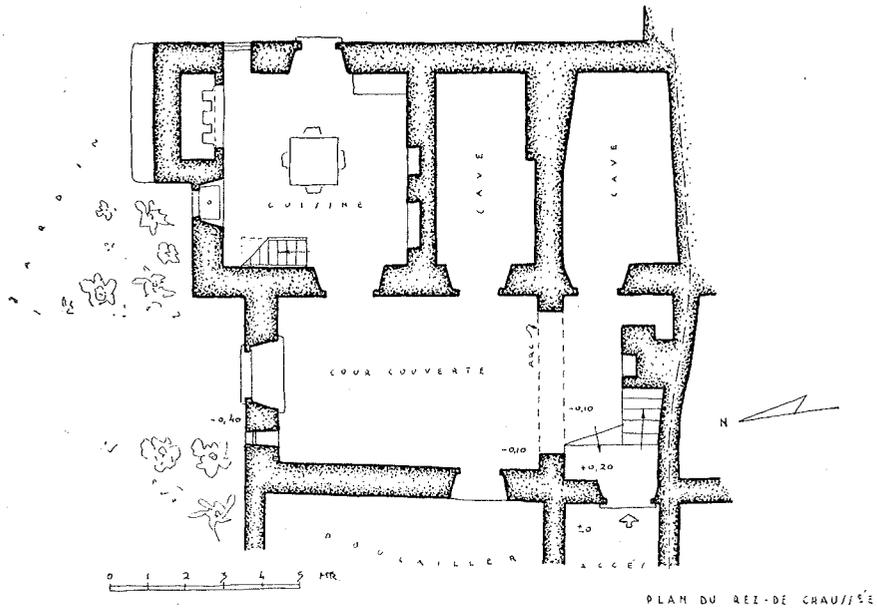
Maison à Chora. Plan du rez-de-chaussée
